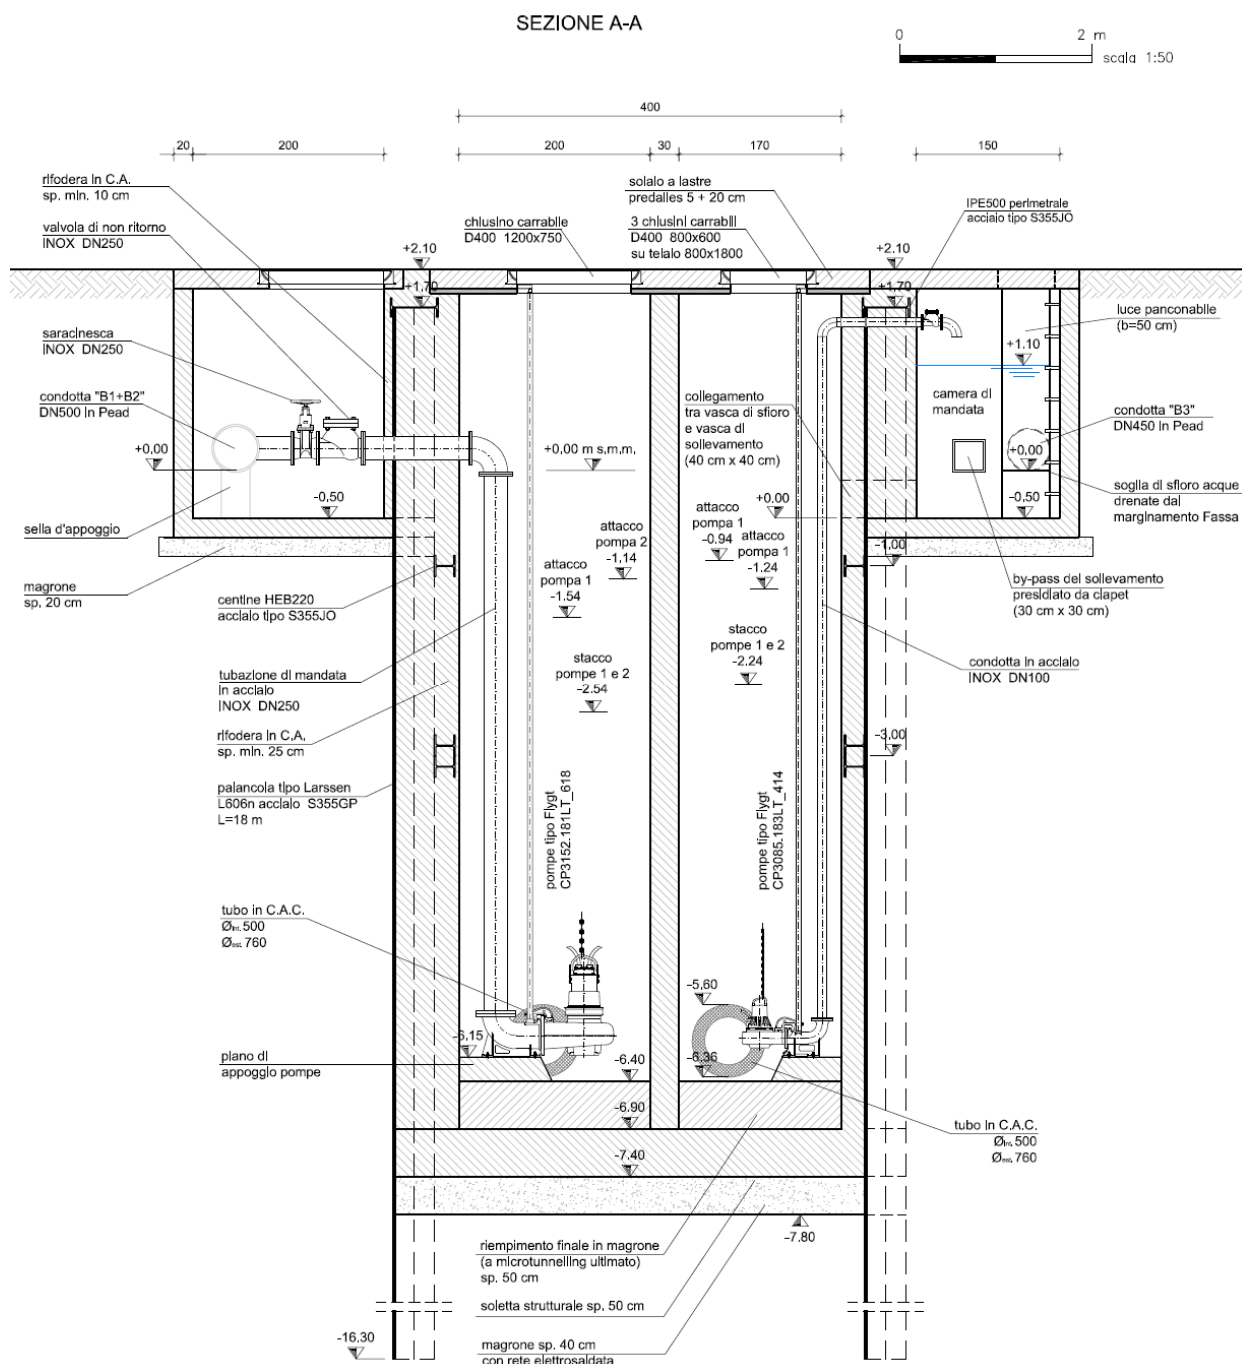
sezione A-A della stazione di sollevamento "Fassa"
